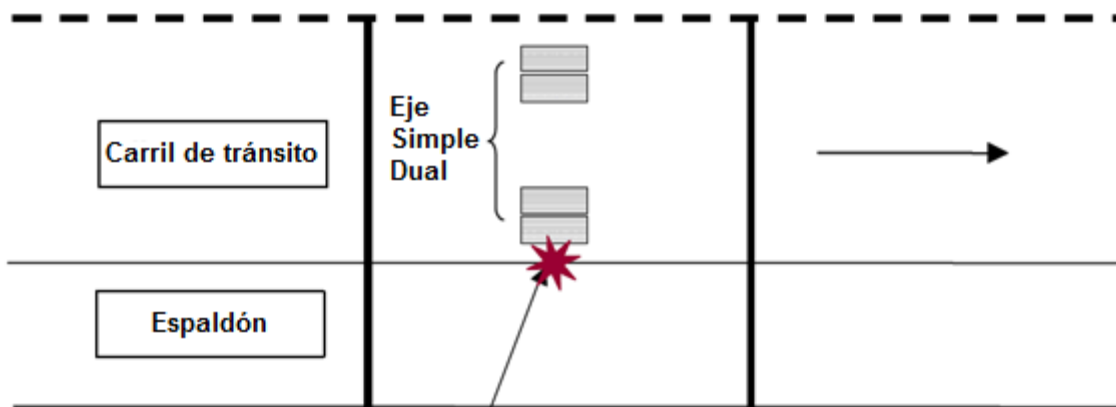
Criterio de falla de la Guía de Pavimentos Empírico-Mecanicista para agrietamientos de abajo hacia arriba.
